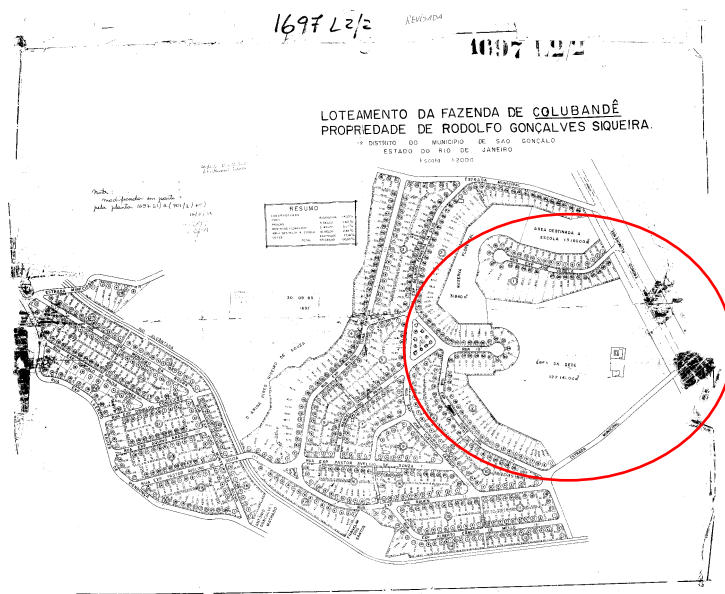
PLANTA DO LOTEAMENTO FAZENDA DO COLUBANDÊ - IMAGEM PMSG
